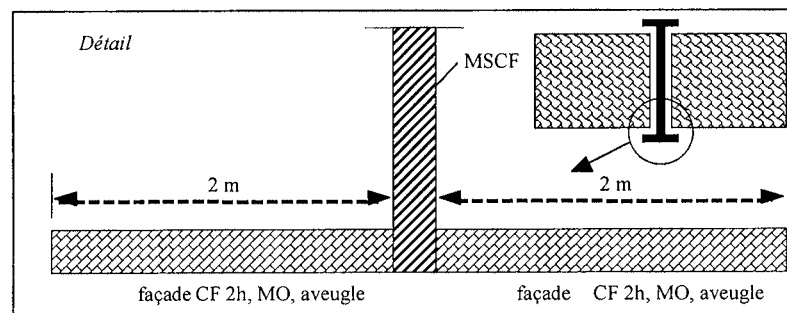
b. - Exception au dépassement sur les côtés du MSCF façade CF 2H, MO et aveugle.
